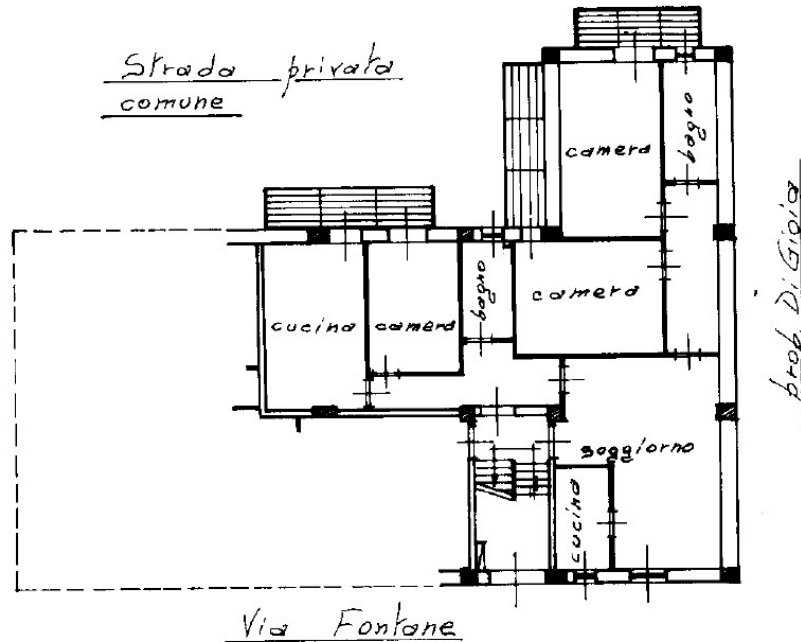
Planimetria dell'appartamento ubicato alla via Fontane n° 22 – interni 3 e 4 - piano rialzato.
